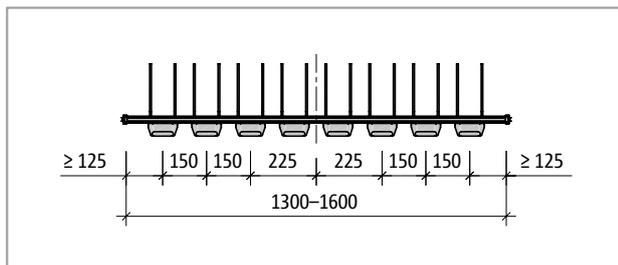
Schöck Tronsole® Typ T-V8-...-L1300 bis L1600: Produktgrundriss
